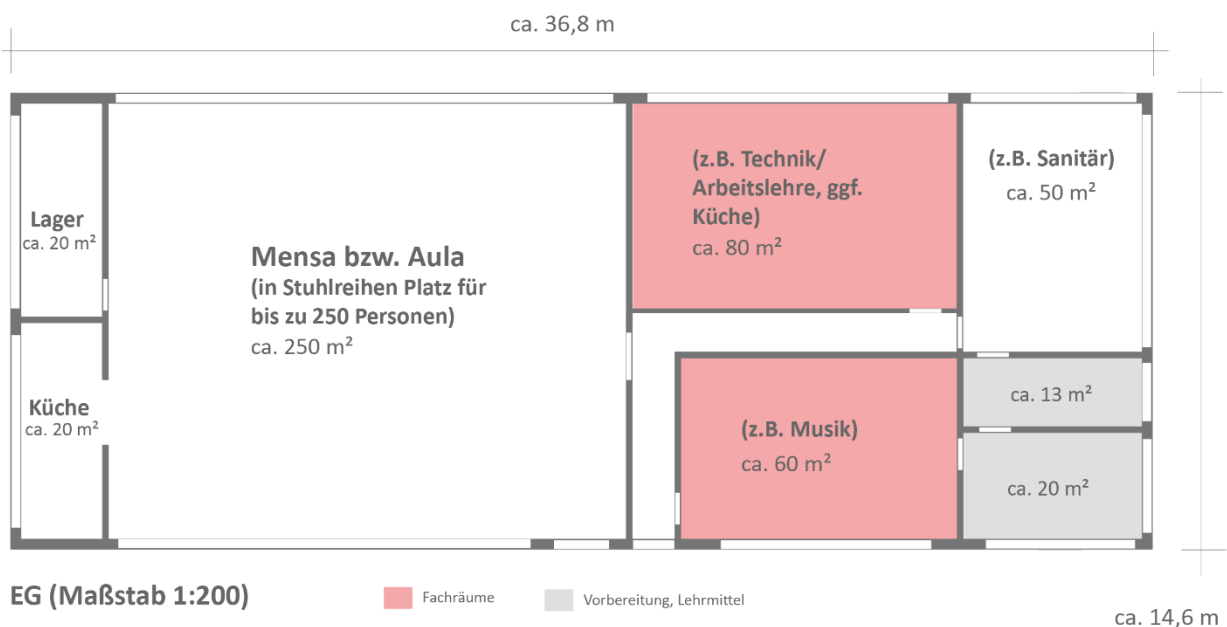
Grundrissvariante 1 für den Neubau einer Mensa/ Aula
